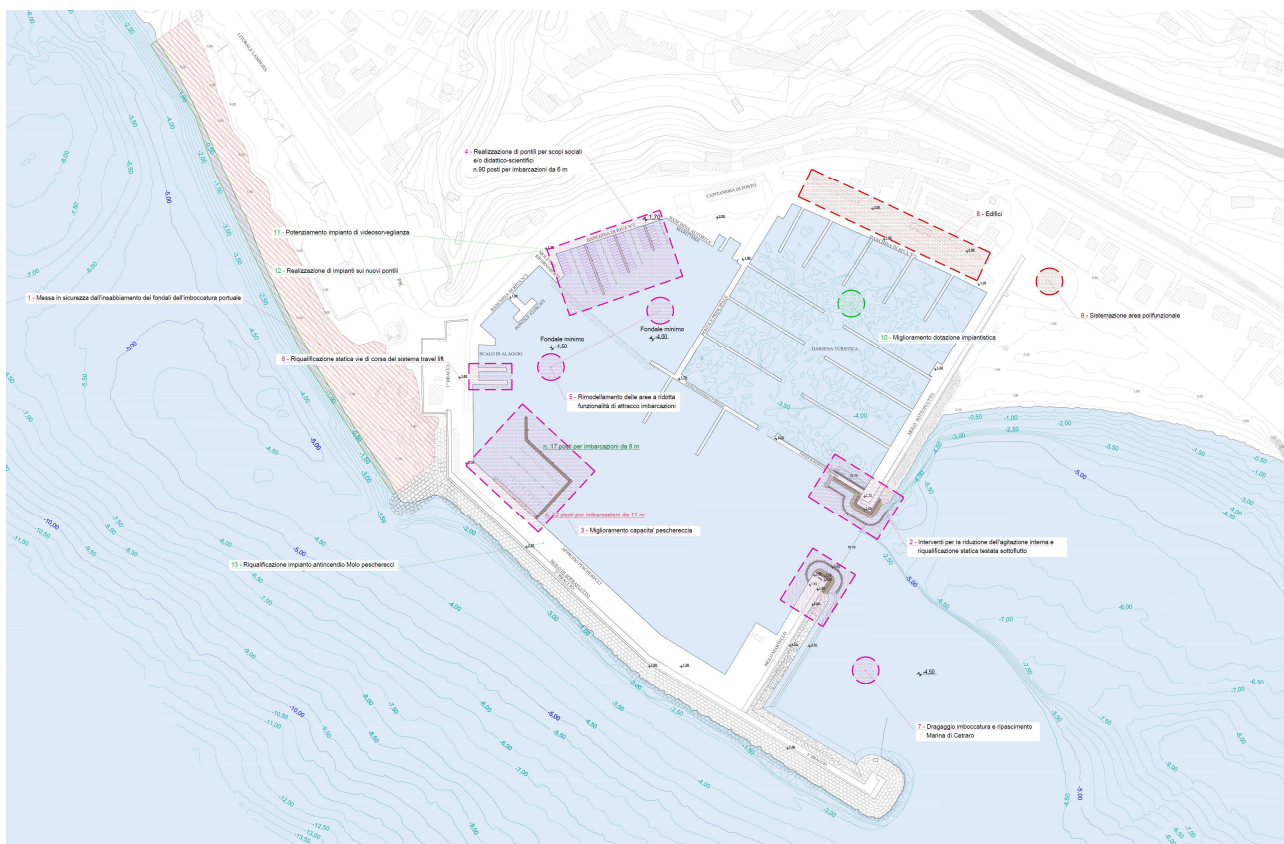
Stralcio Planimetria generale di progetto esecutivo
